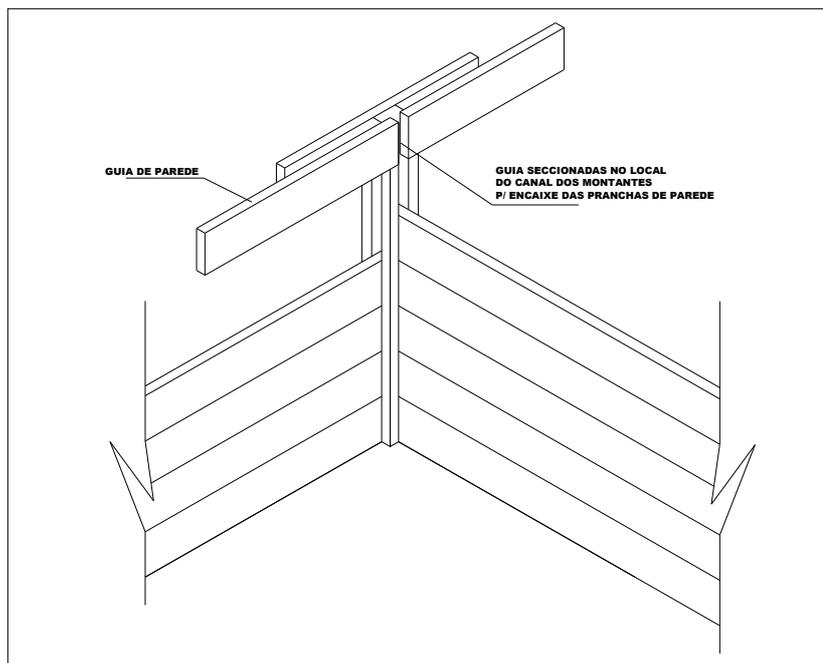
Precasa (2000) - Guia de parede.
